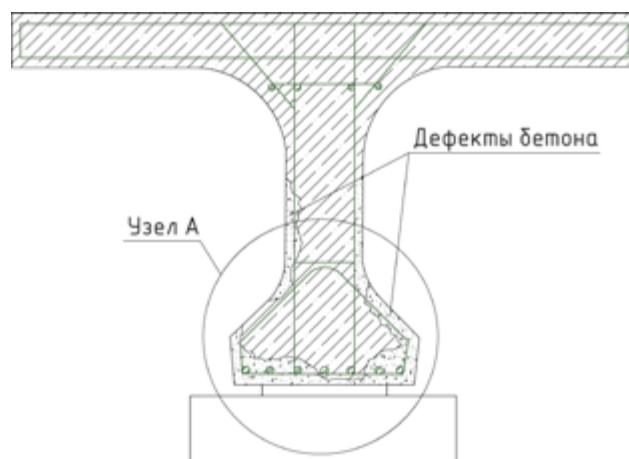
Разрушение защитного слоя арматуры балки пролетного строения
